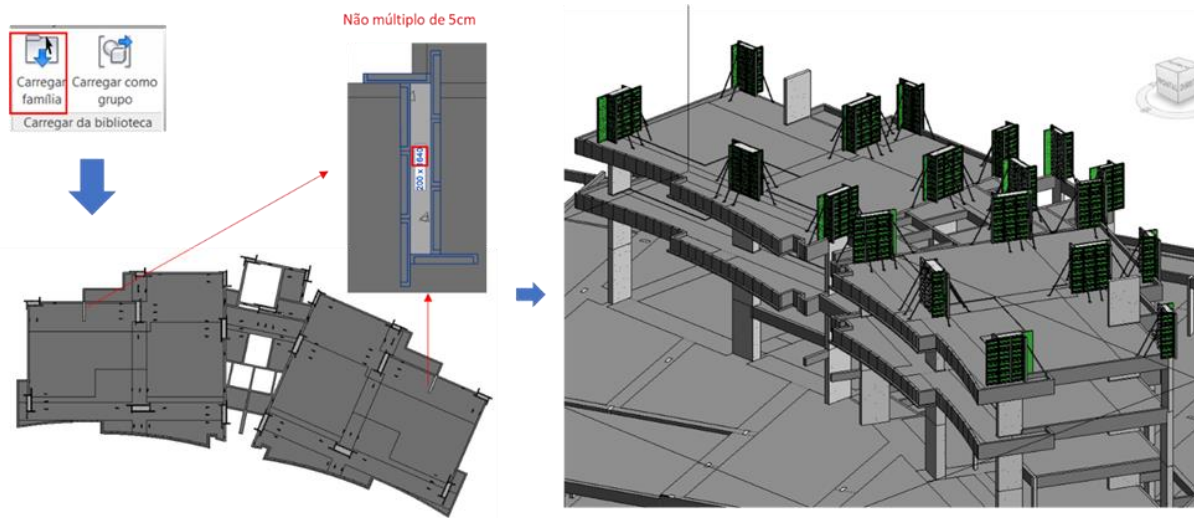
Família fôrma de pilar inserido no pavimento tipo de teste
